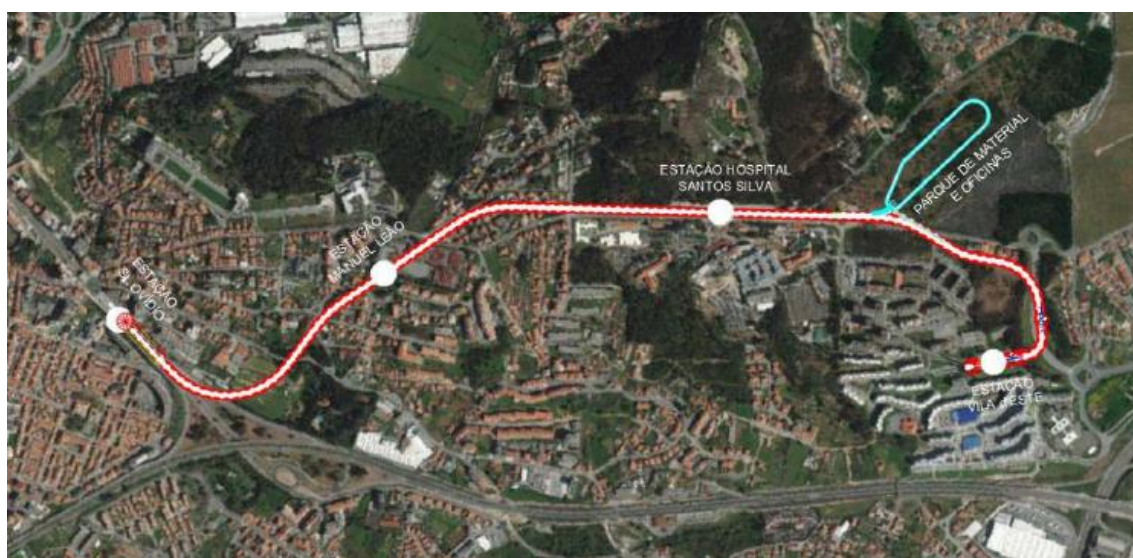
Planta de Implantação Prolongamento da Linha Amarela
